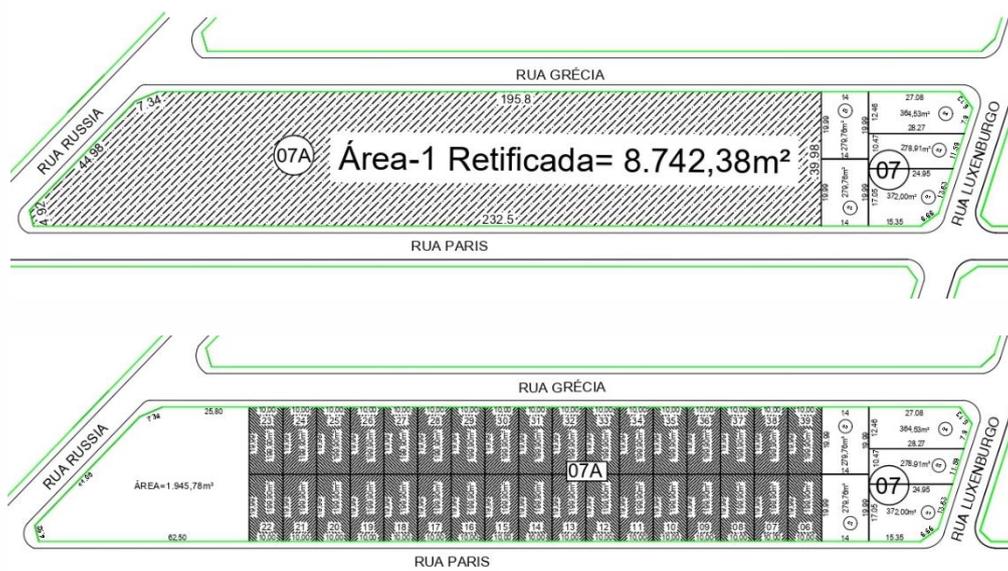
Localização da Área Institucional 1, Quadro 07A, bairro Jardim Europa (área retificada) - Santa Helena de Goiás/GO
